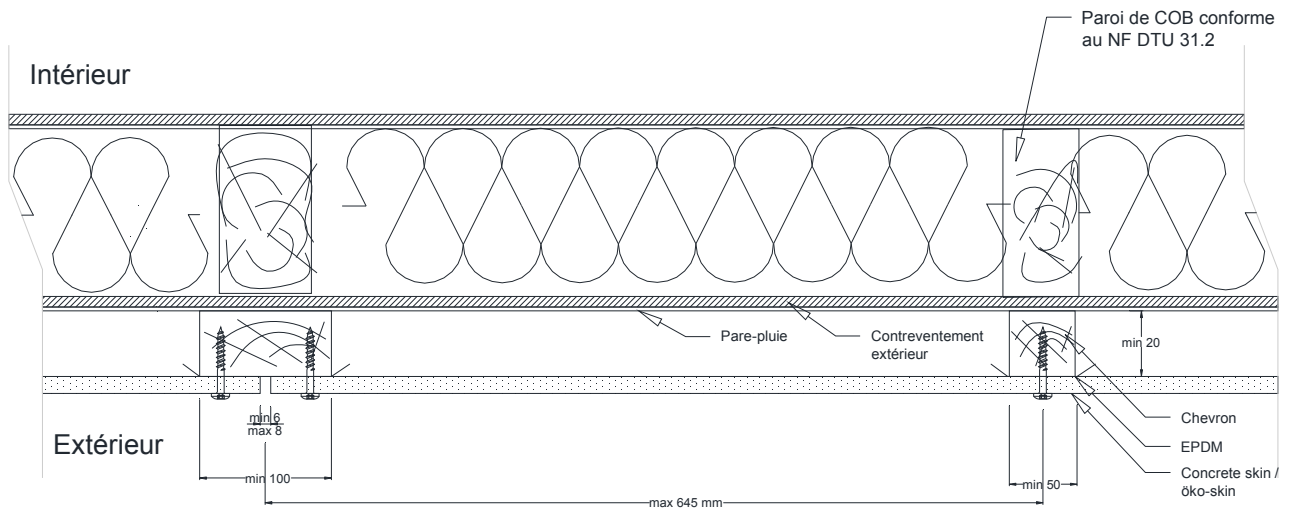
Pose sur COB – Coupe horizontale avec chevron
